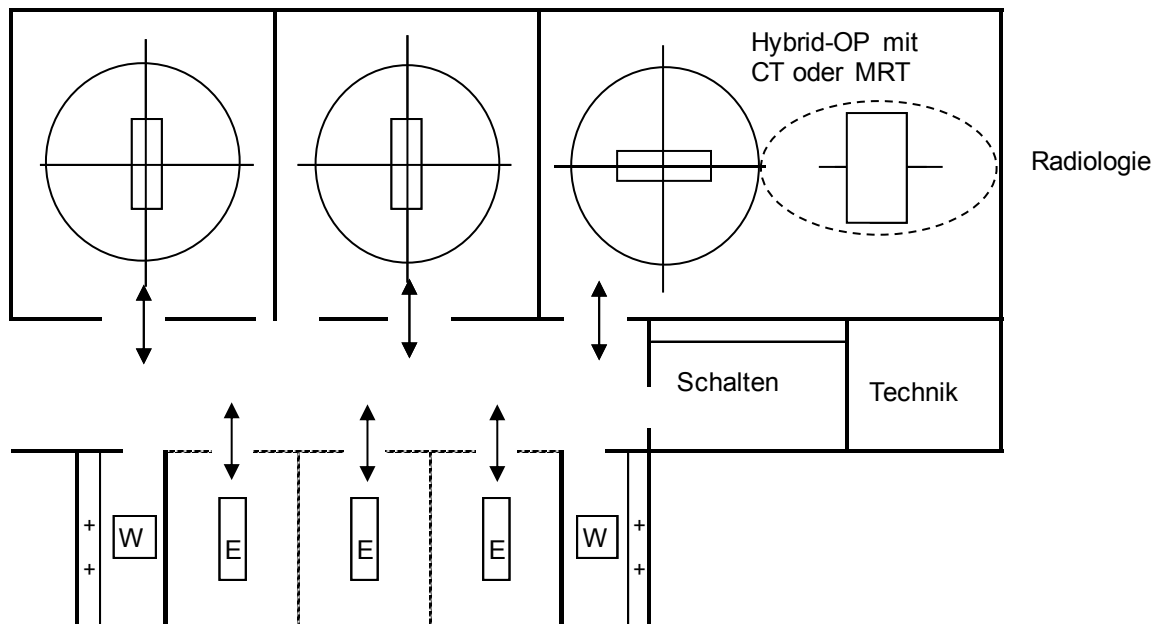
Systemgrundriss Hybrid-OP mit CT
